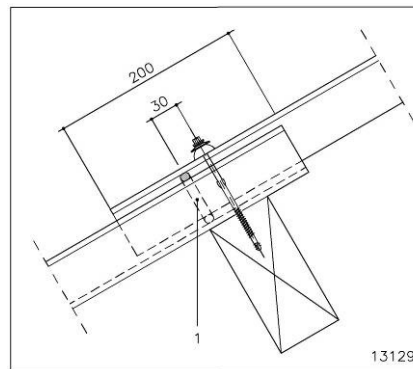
Cordon d'étanchéité dans le recouvrement longitudinal
